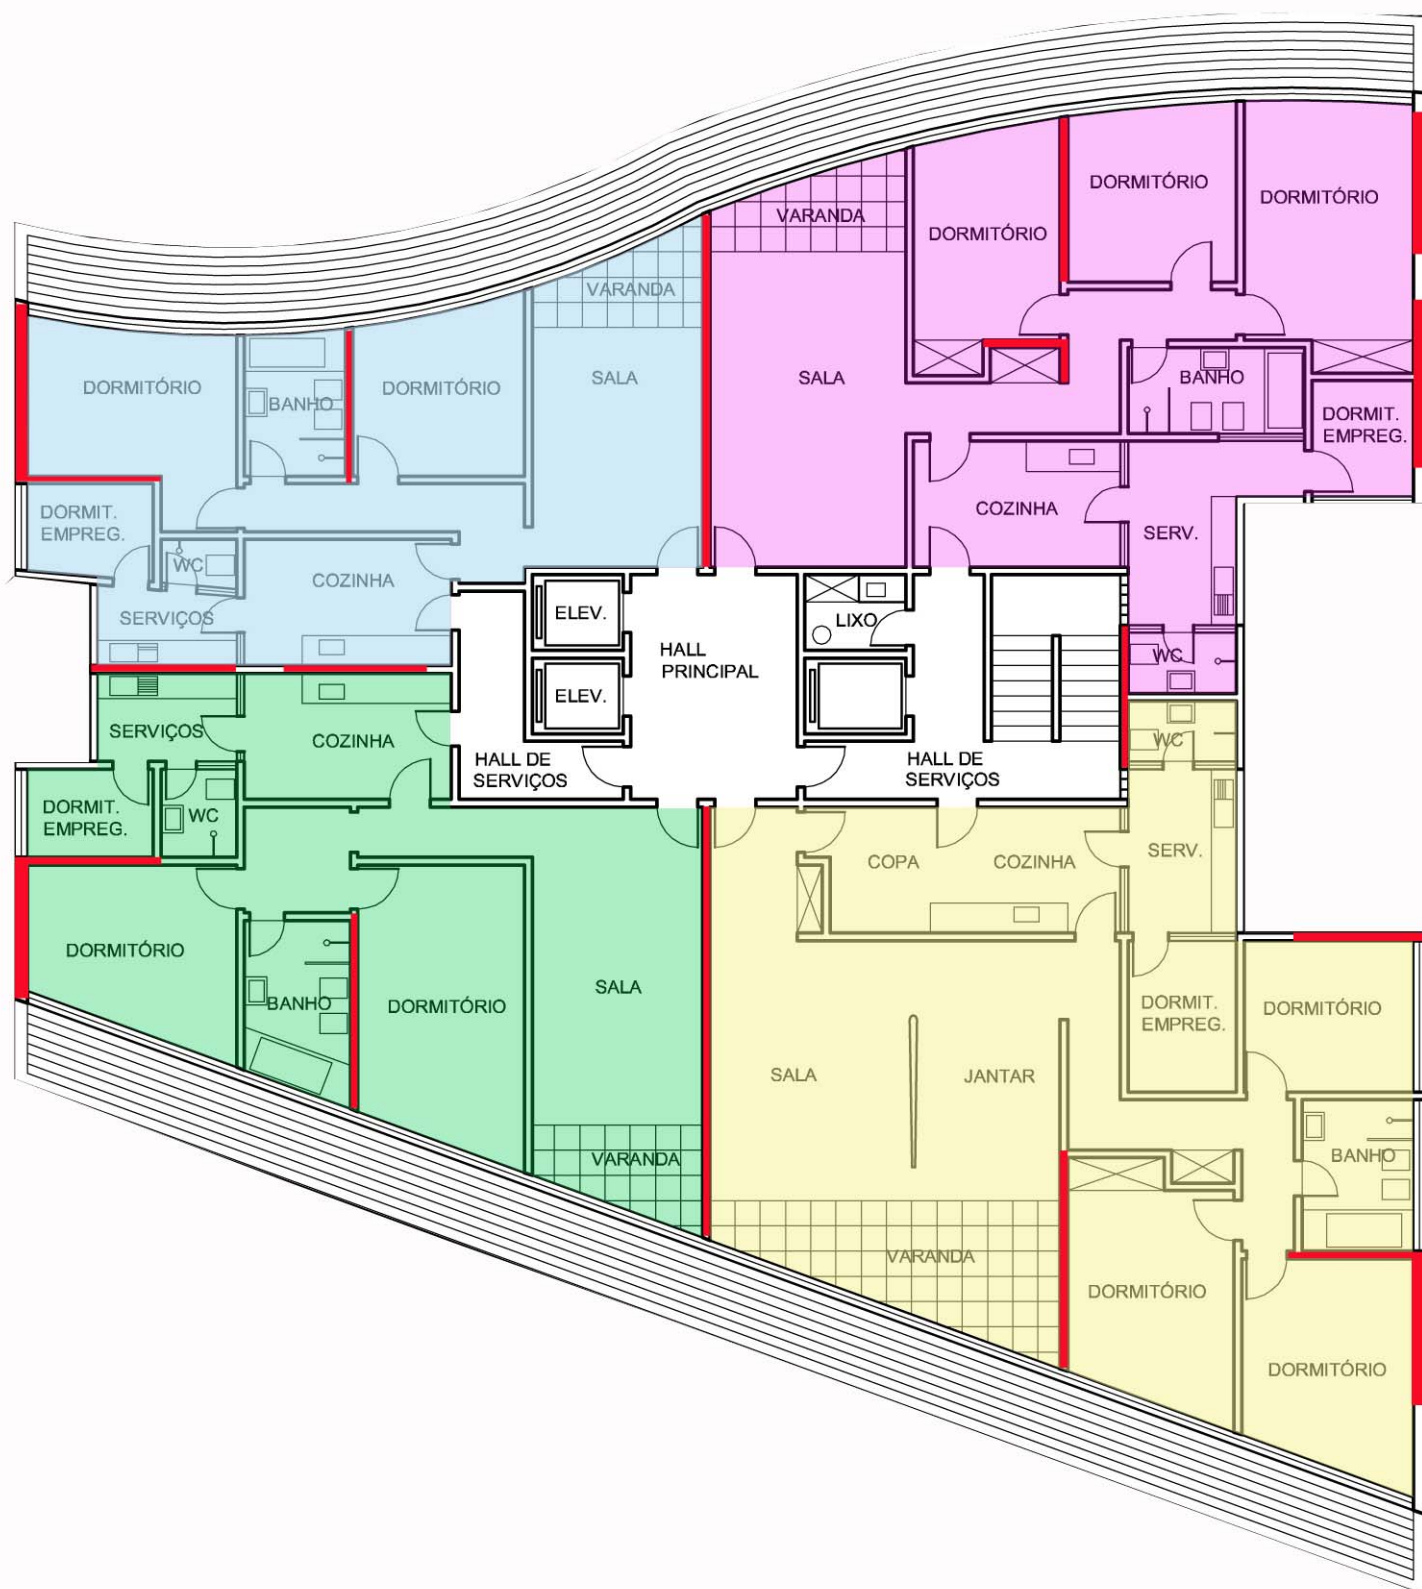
Planta Pavimento Tipo. Indicação dos quatro apartamentos - áreas. Em vermelho os pilares do pavimento tipo. Desenho a partir de Dezan (2007).
